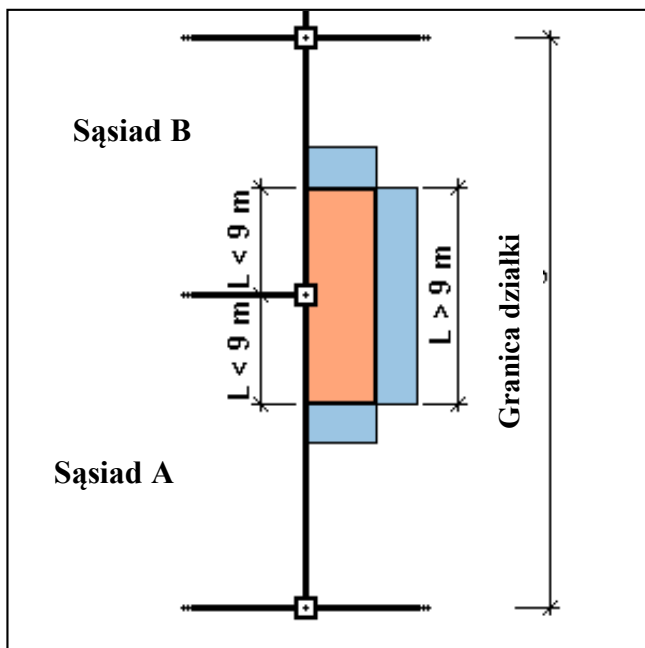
Dopuszczalna uprzywilejowana przybudówka przy istniejącej dopuszczalnej prawem planowania przestrzennego zabudowie granicznej
